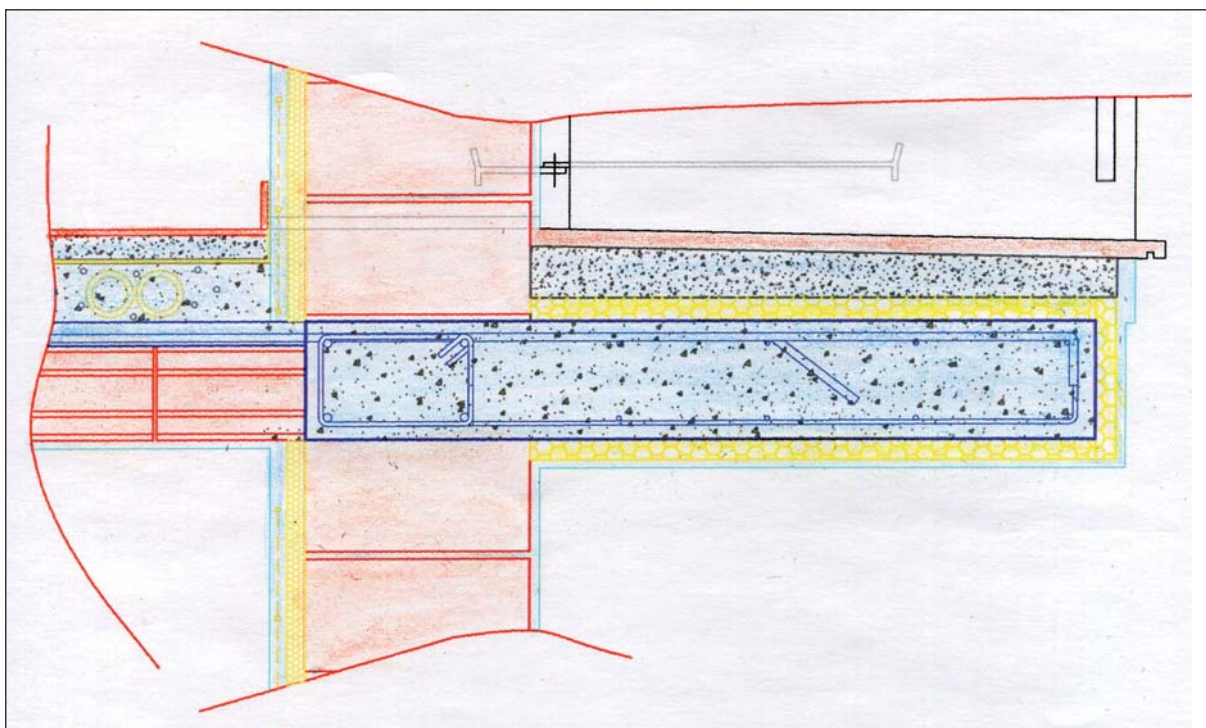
Correzione ponte termico balcone con isolamento perimetrale della struttura in aggetto.
